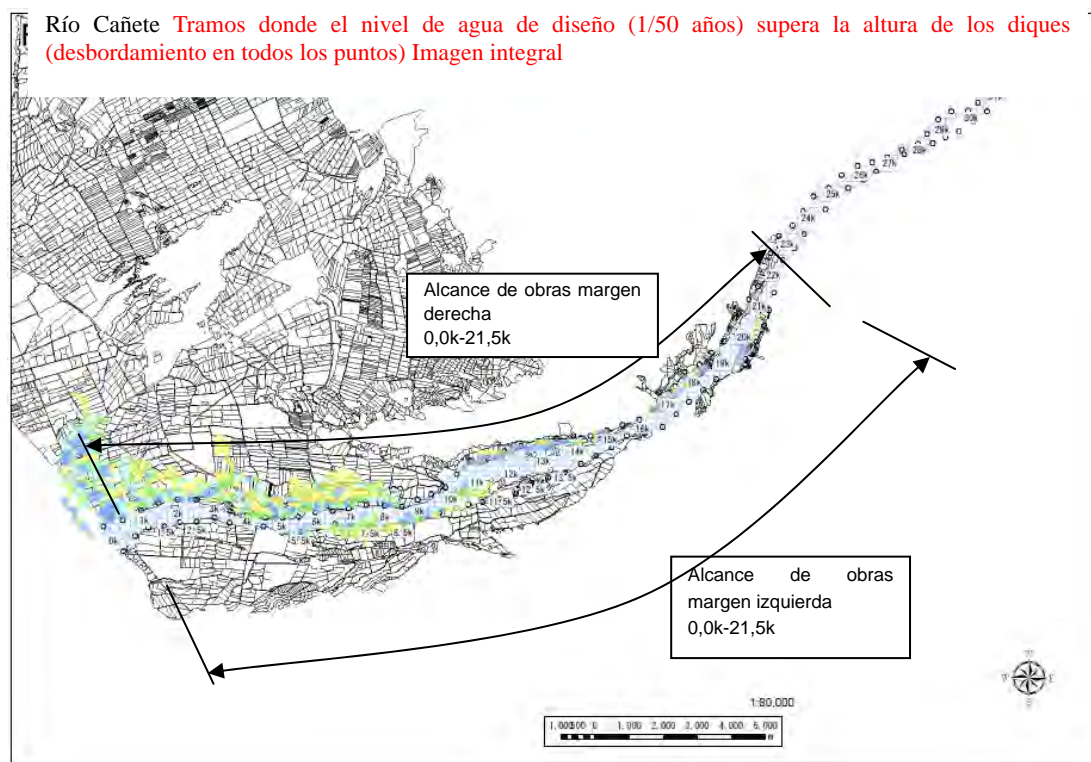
Plan de construcción de diques en el Río Cañete
